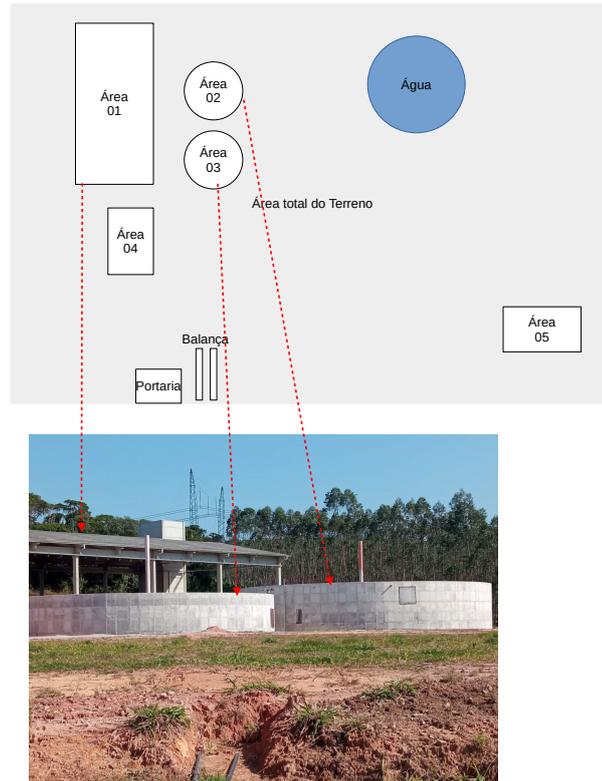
Foto das duas estruturas em concreto armado para acumular a biomassa, tendo a área 1 ao fundo. Fonte: Autor.
